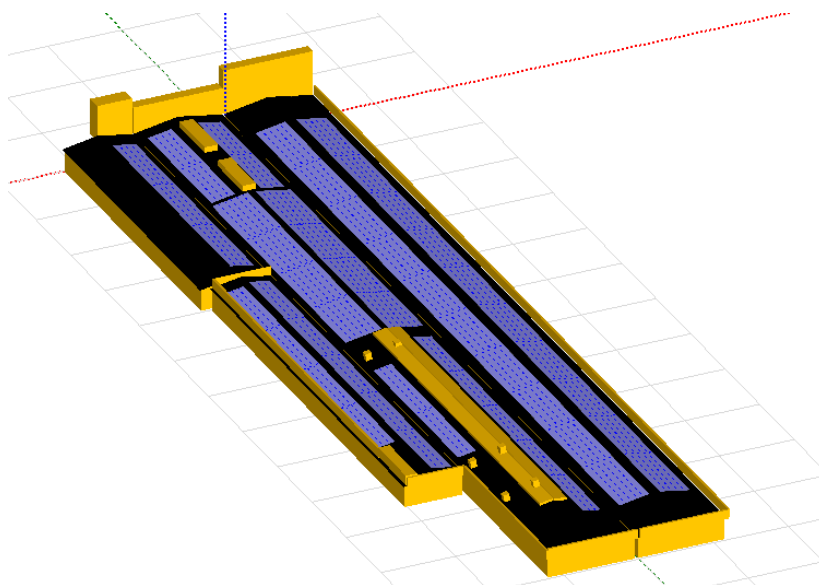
Modelo 3D de la nave con los paneles abatidos sobre cubierta
